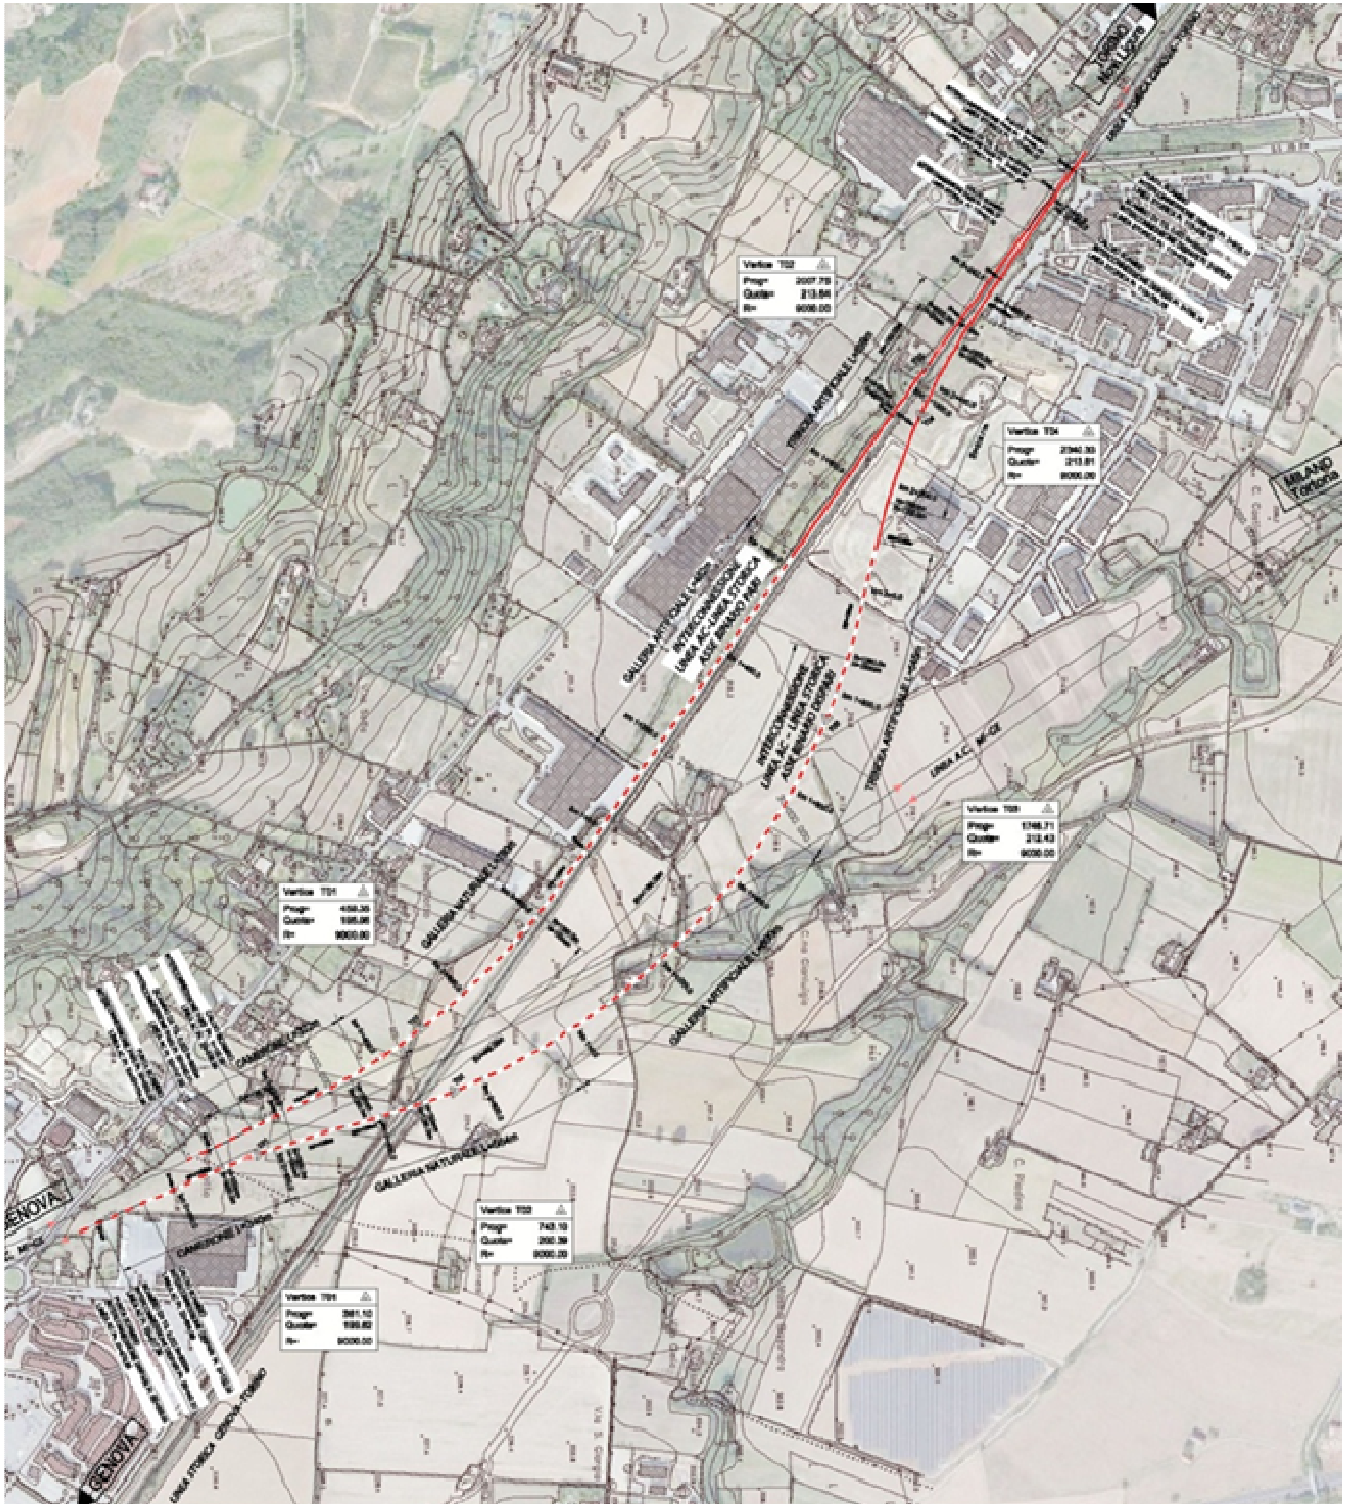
A - Stralcio planimetrico dell'ipotesi prescelta nello Studio di Fattibilità per il tratto in ambito extraurbano
